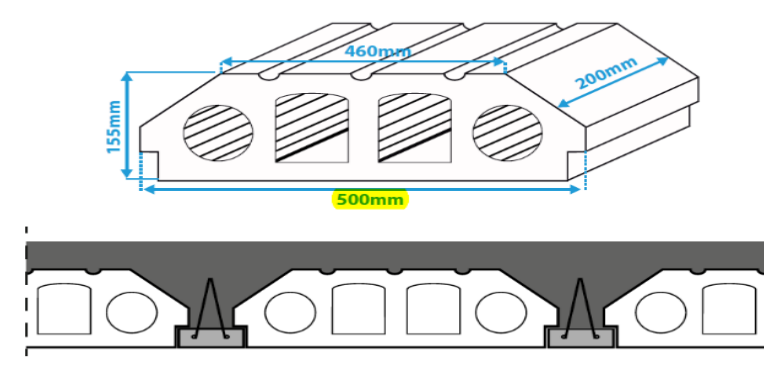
Coupe d'un plancher en corps creux (ancien mémoire)
